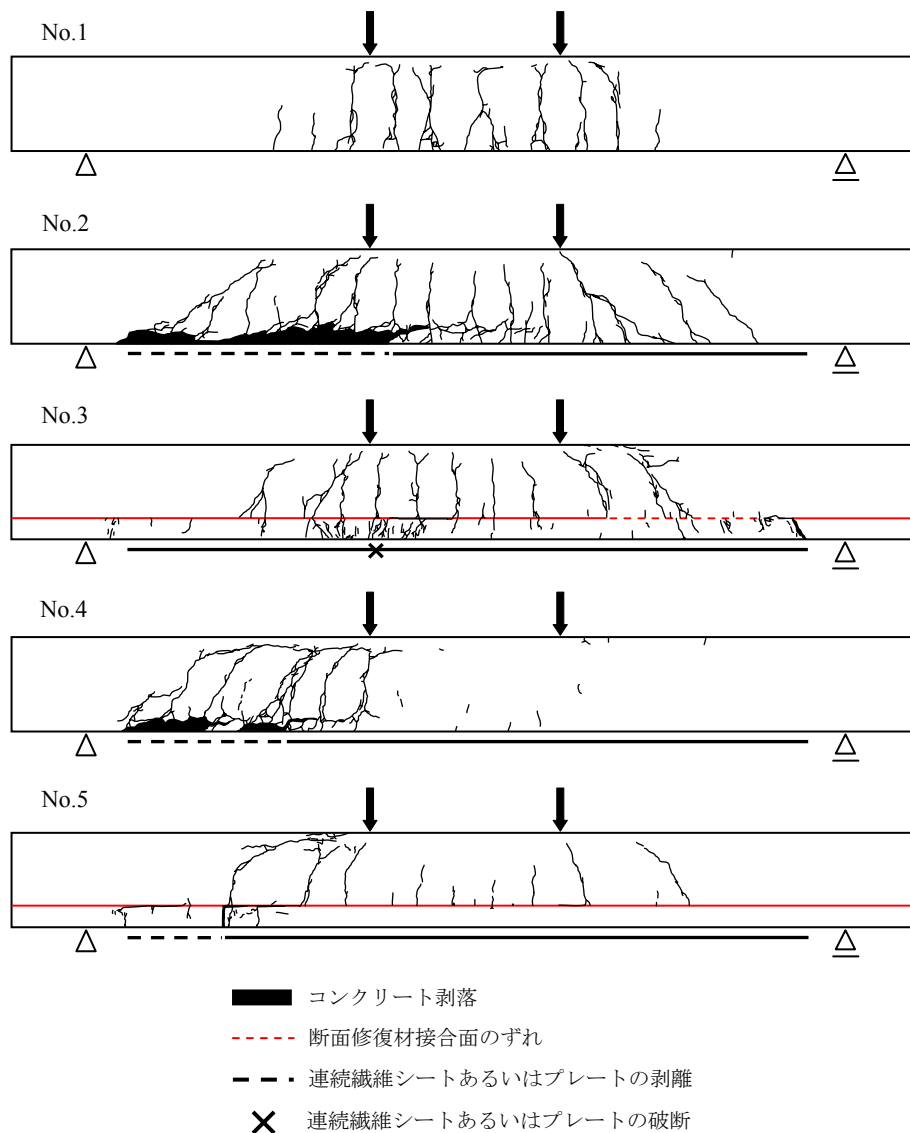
RC 梁試験体のひび割れおよび終局破壊性状
